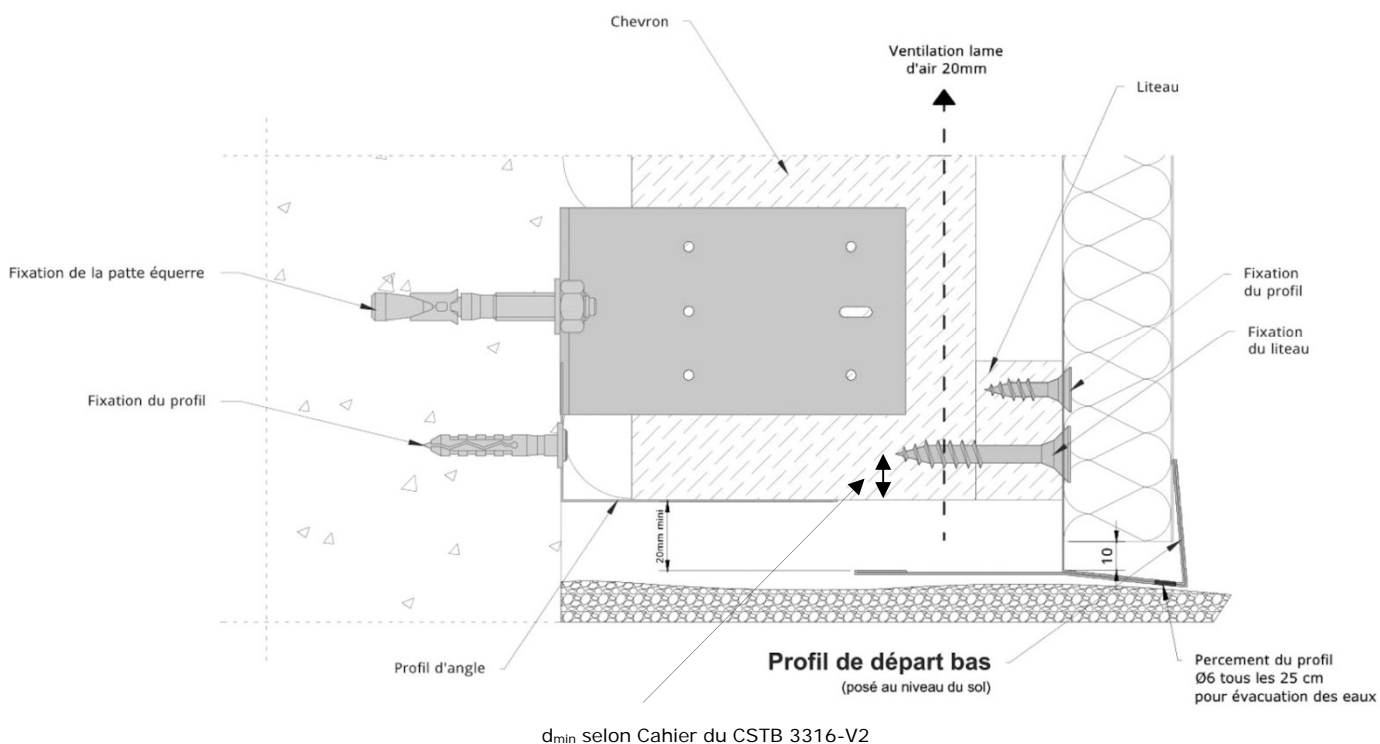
2 - Bas de façade – Pose en bardage rapporté double réseau, lames verticales (coupe verticale)
